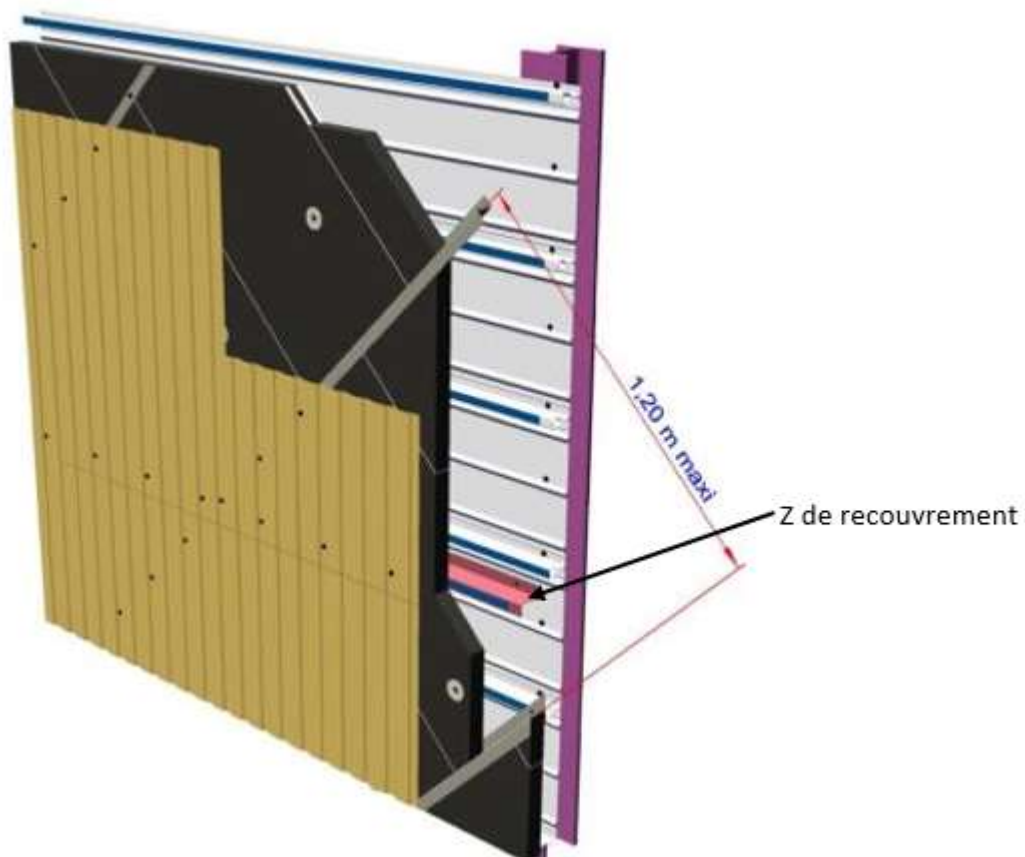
Z de recouvrement pour un bardage avec plateaux horizontaux, Z à 45° et peau d'étanchéité verticale
